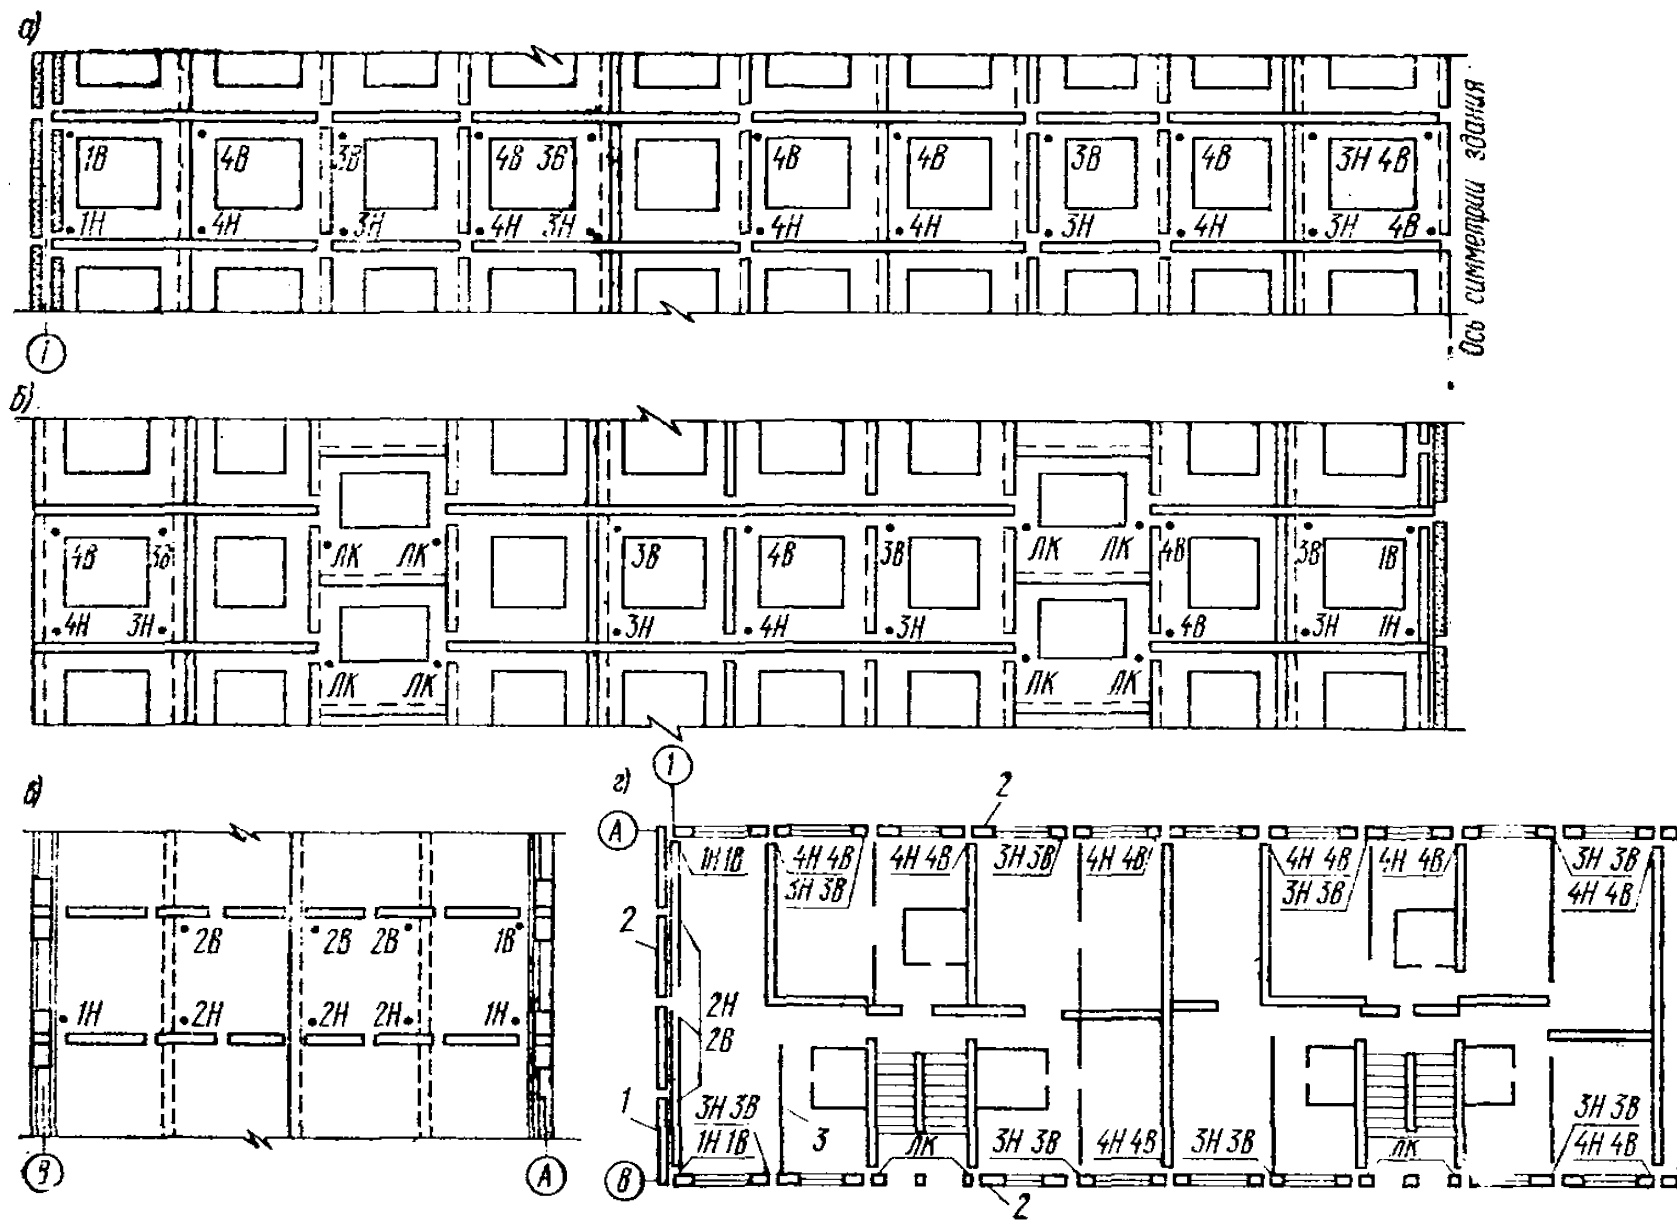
Расположение стальных элементов в наружных стенах домов серии 1-468
